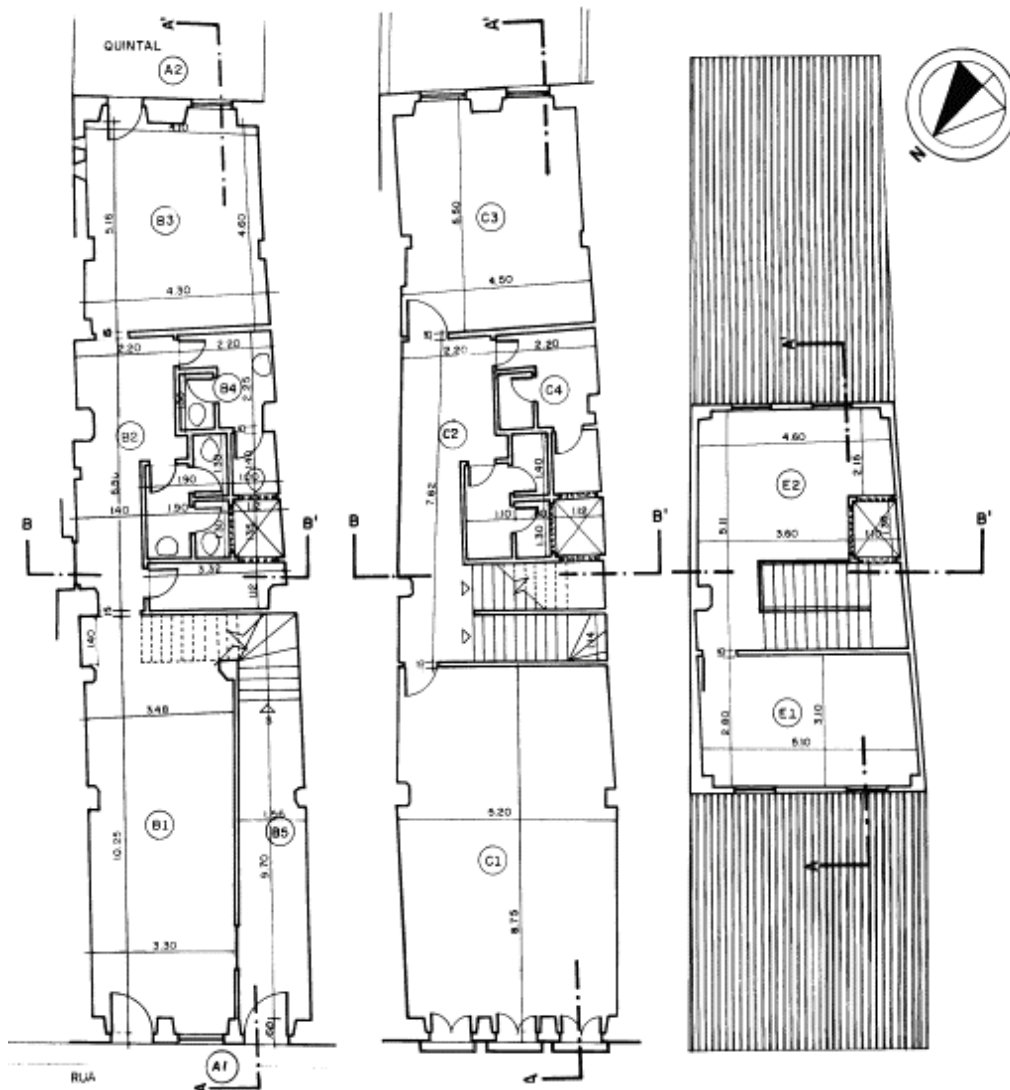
Plantas baixas do térreo, primeiro pavimento e sótão do sobrado da rua Gregório de Matos nº 21.
